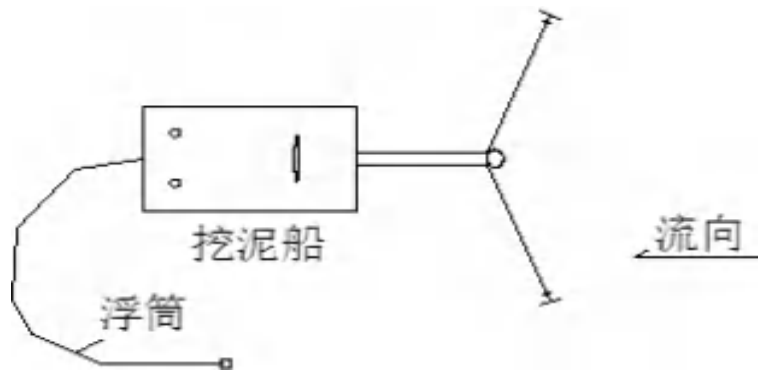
绞吸式挖泥船钢桩定位施工锚缆布置示意图
